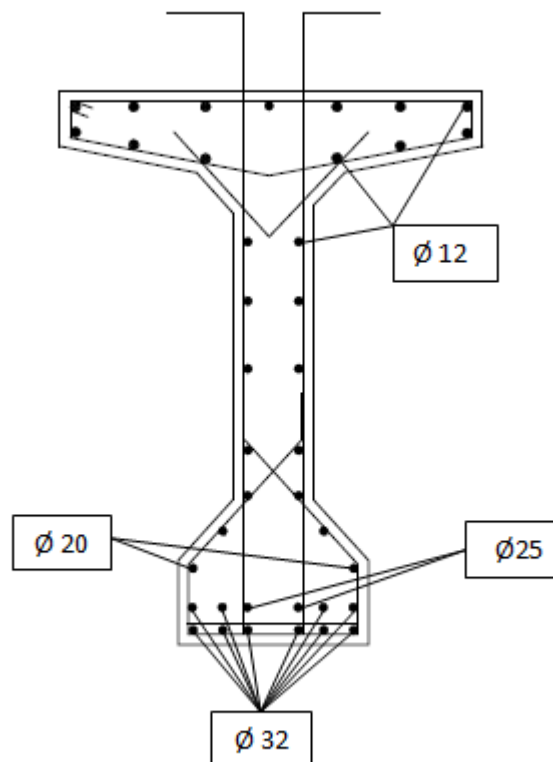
Ferrailage de la poutre en BA a la zone médiane.
